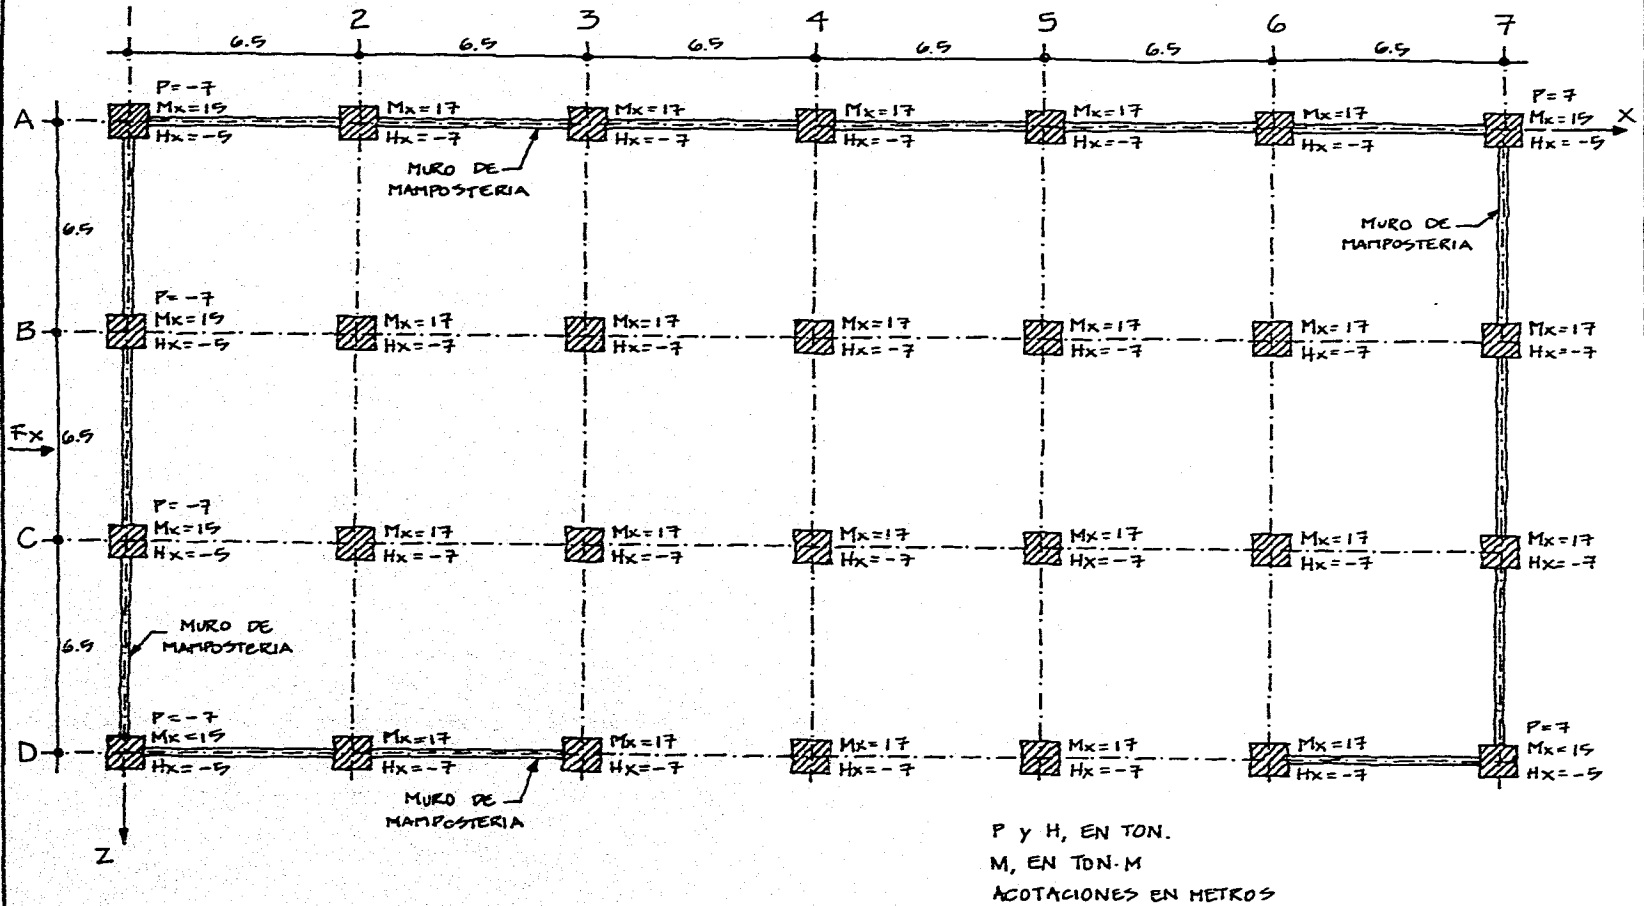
PLANTA DE CARGAS POR COLUMNAS AL NIVEL DE CIMENTACION
